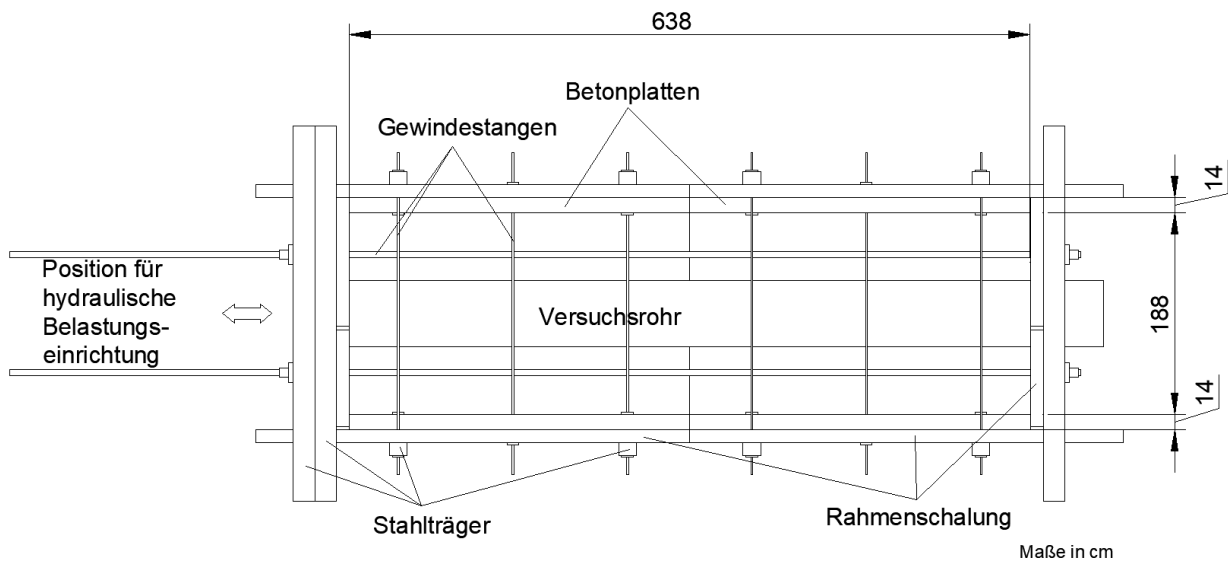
Versuchsstand, Grundriss
